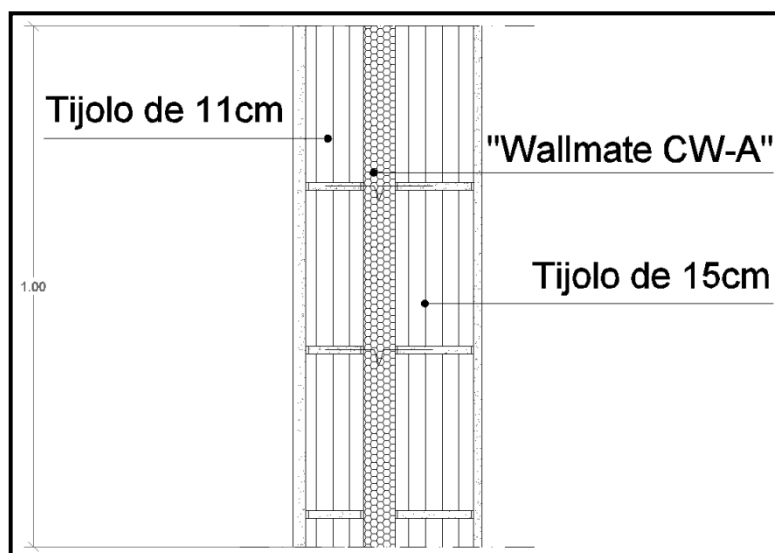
Pormenor em planta, da parede de pano duplo de 36cm de espessura
